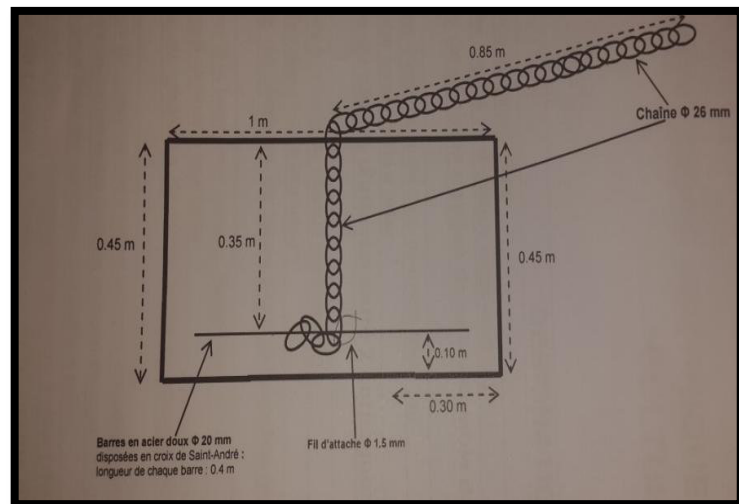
Les dimensions d'un corps-mort avec chaîne immergée attachée à deux barres en acier doux disposées en croix. (Coupe transversal) (Culture marine).
